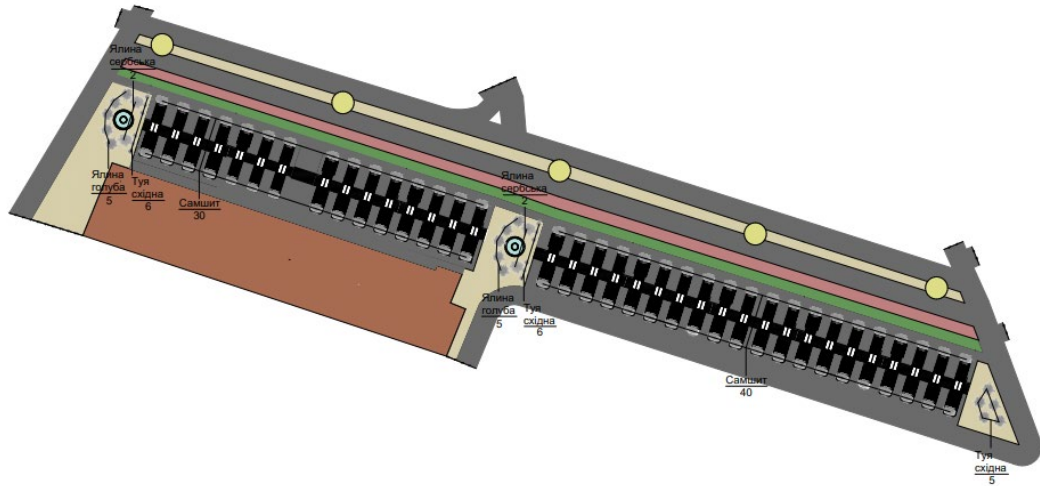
Дендроплан другої ділянки
